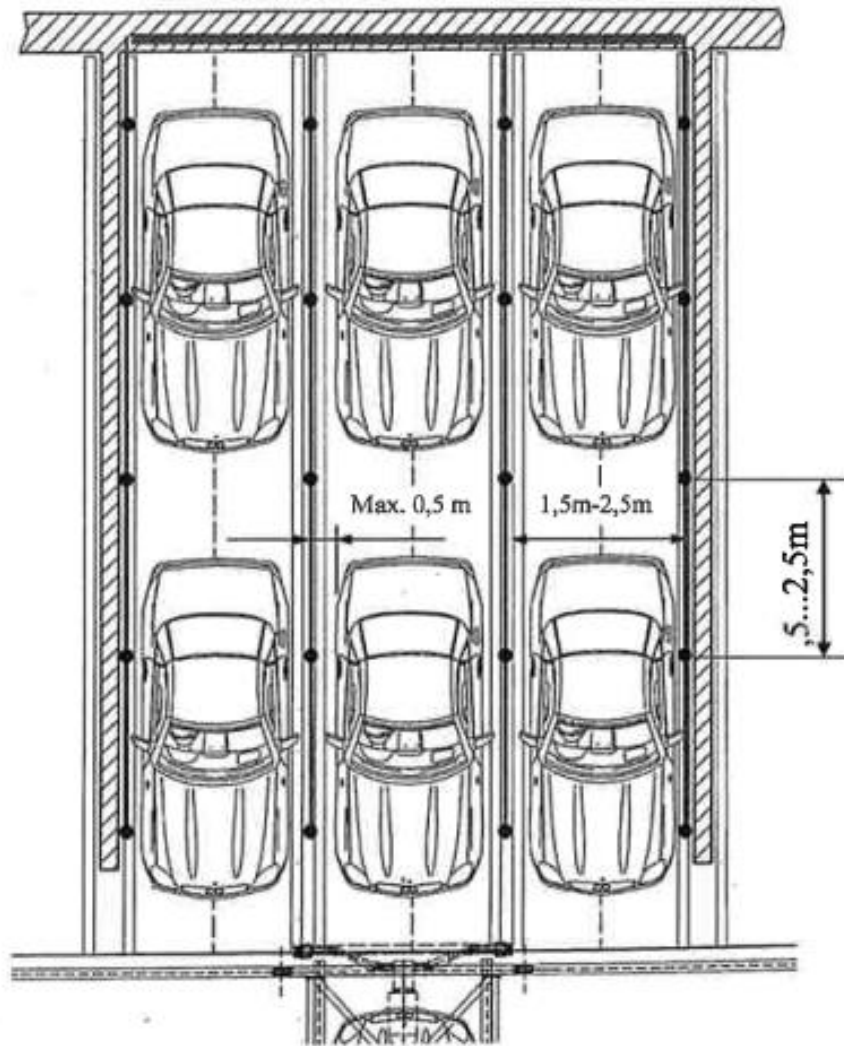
Vertikalt eksempel på sprinkleroppsett i et automatisk parkeringsanlegg over tre plan (77).
